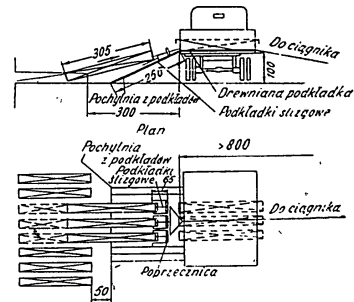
Wyposażenie dla wykonywania naładunków i wyladunków płyt.
